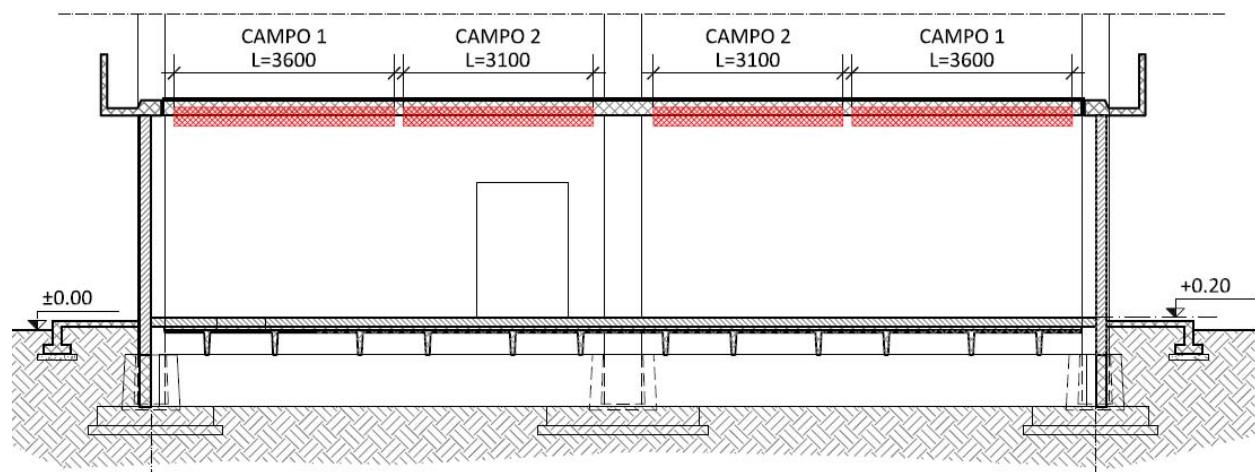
Intervento 09 – Individuazione in sezione dell'intervento
